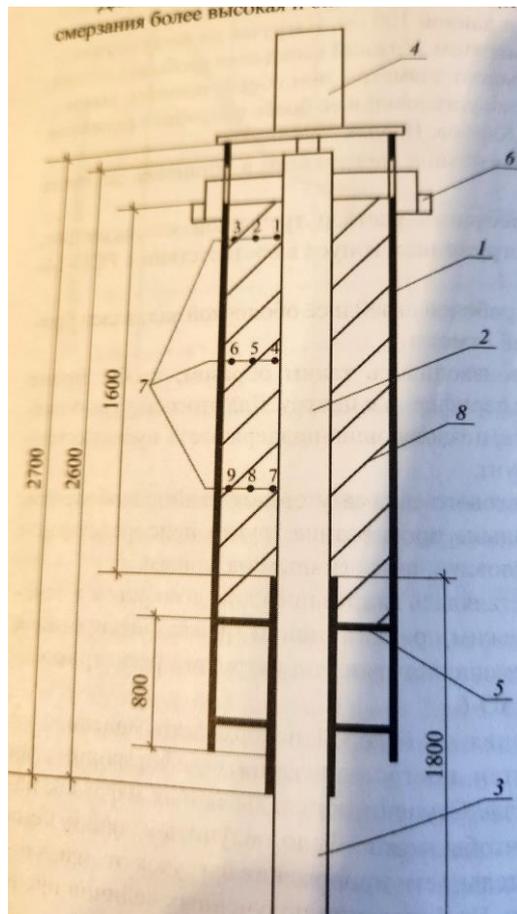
Схема установки для определения сил смерзания модели сваи с грунтом:
